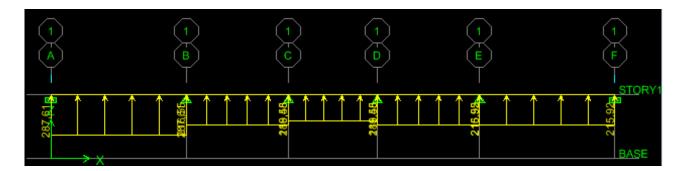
Schéma statique de la nervure ELS (sens longitudinal).
